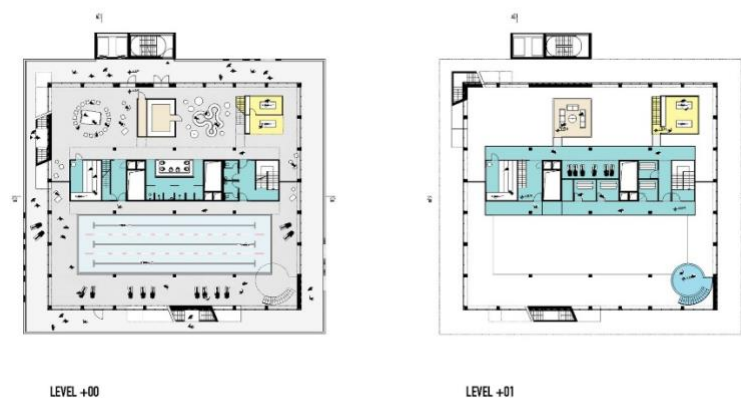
Plantas de pavimento do projeto Werk 12 (2019)
